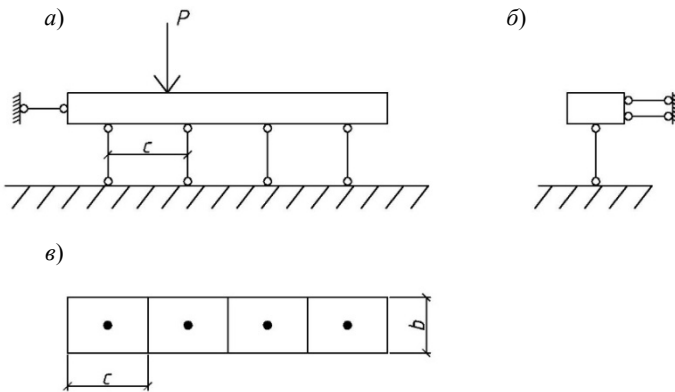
Расчетная схема балки в продольном (а) и поперечном (б) сечениях, расположение фиктивных стержней в плане (в)
